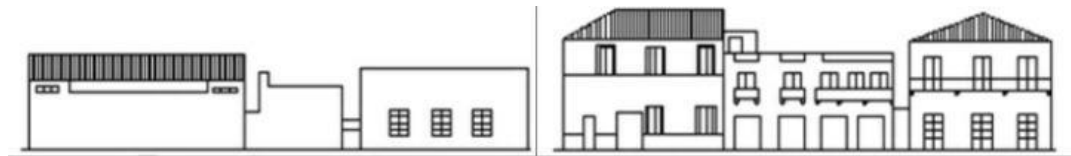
Façade urbaine donnant sur l'habitat colonial du noyau
